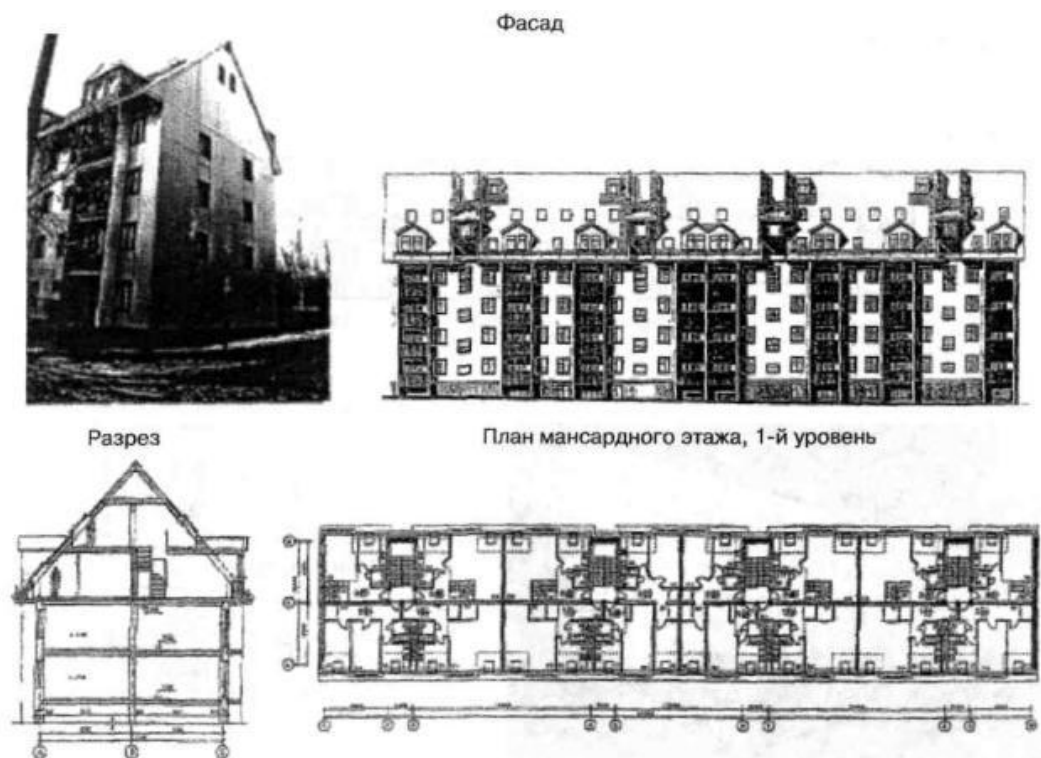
Проект реконструкции жилого дома серии 1-447. Надстройка 2-уровневого мансардного этажа с опорой на пилоны
